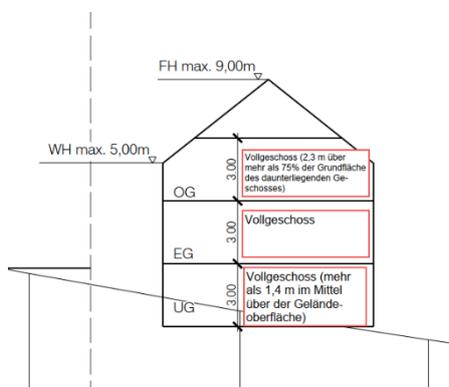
Schemaschnitt mit Darstellung der möglichen Vollgeschosse
